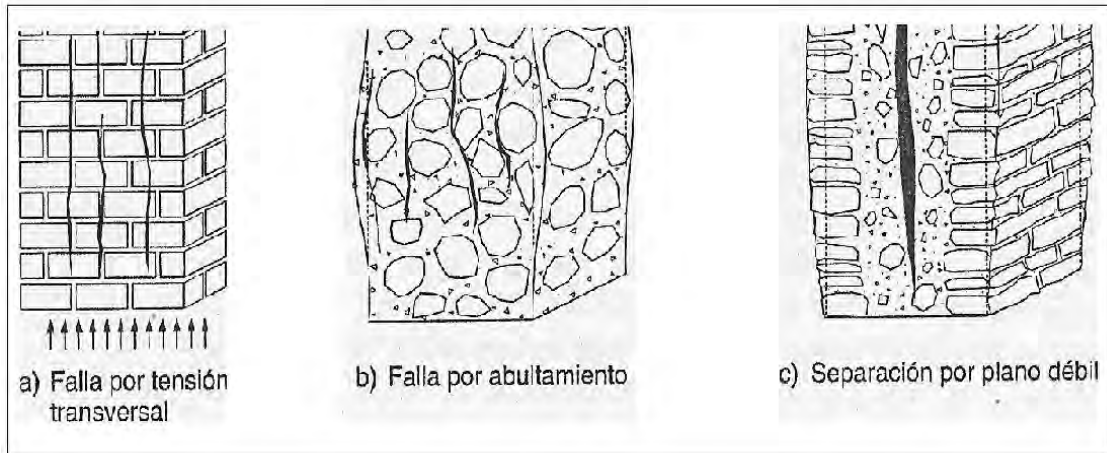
Tipos de falla ante cargas verticales [1].
